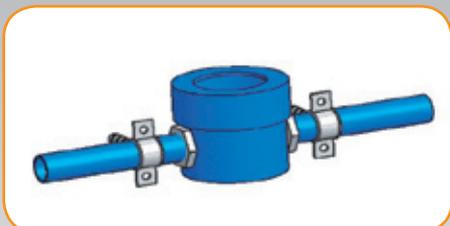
В месте установки элементов арматуры на трубопроводе.
